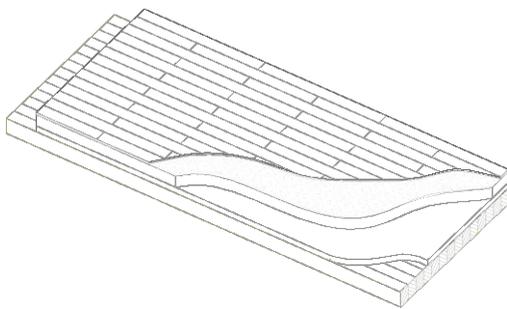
Holzmassivdecke mitsamt Fußbodenaufbau
